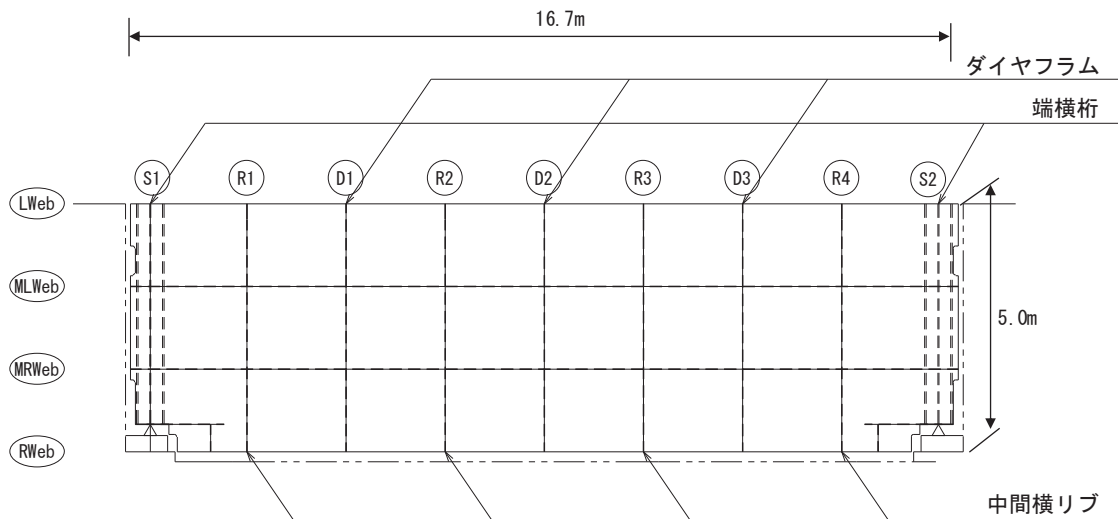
(2) 鋼製遮水壁 (鋼桁 2) 平面図
